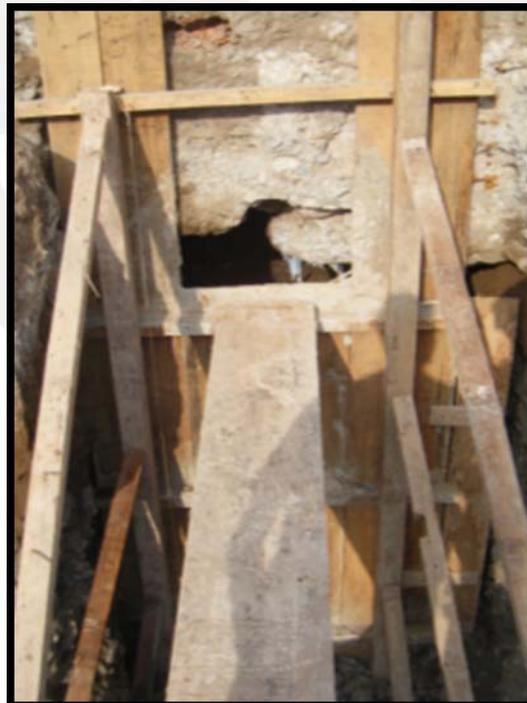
Encofrado de calzaduras lista para vaciar (referencial)
